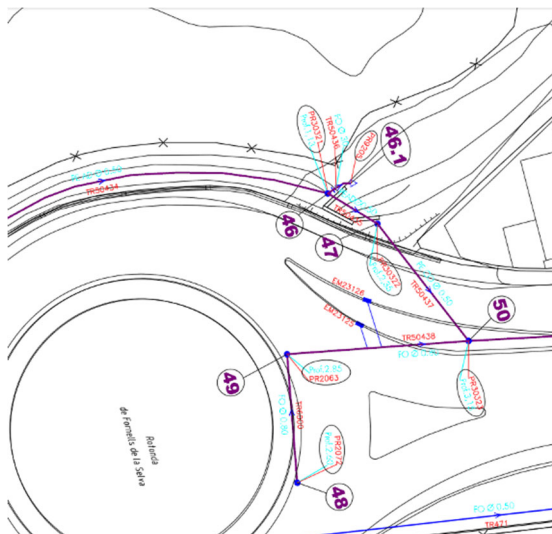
Planta de clavegueram de la zona del sobreeixidor
